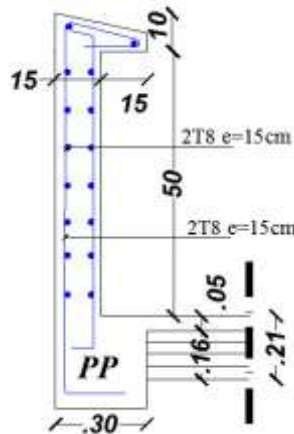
Ferrailage de l'acrotère type1 (Terrasse accessible)
